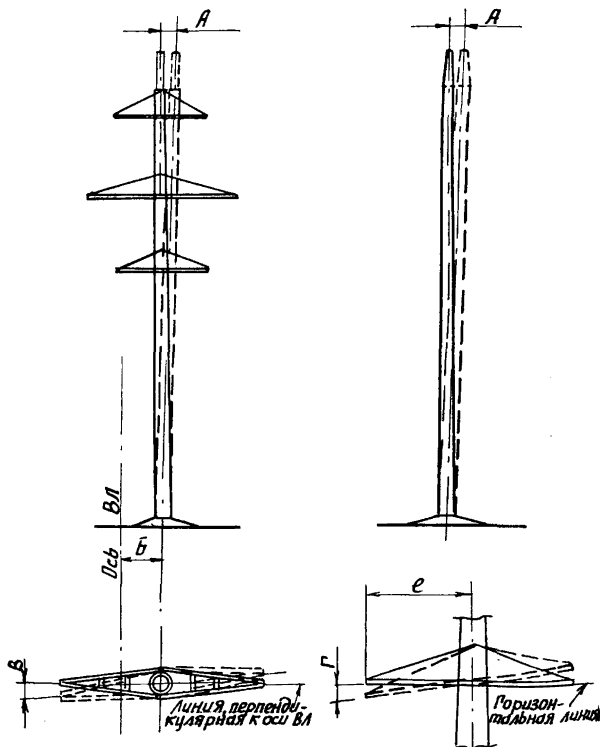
Нормы и допуски на установку одностаечных железобетонных опор
